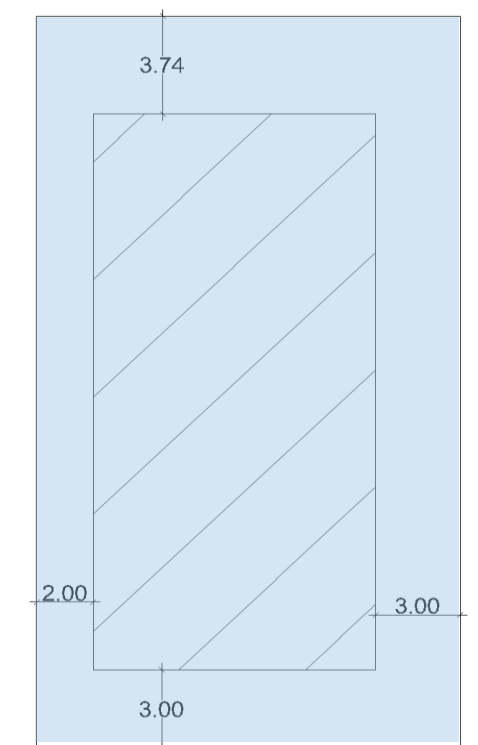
Retiros de lotes de viviendas de modelo Guayacán
